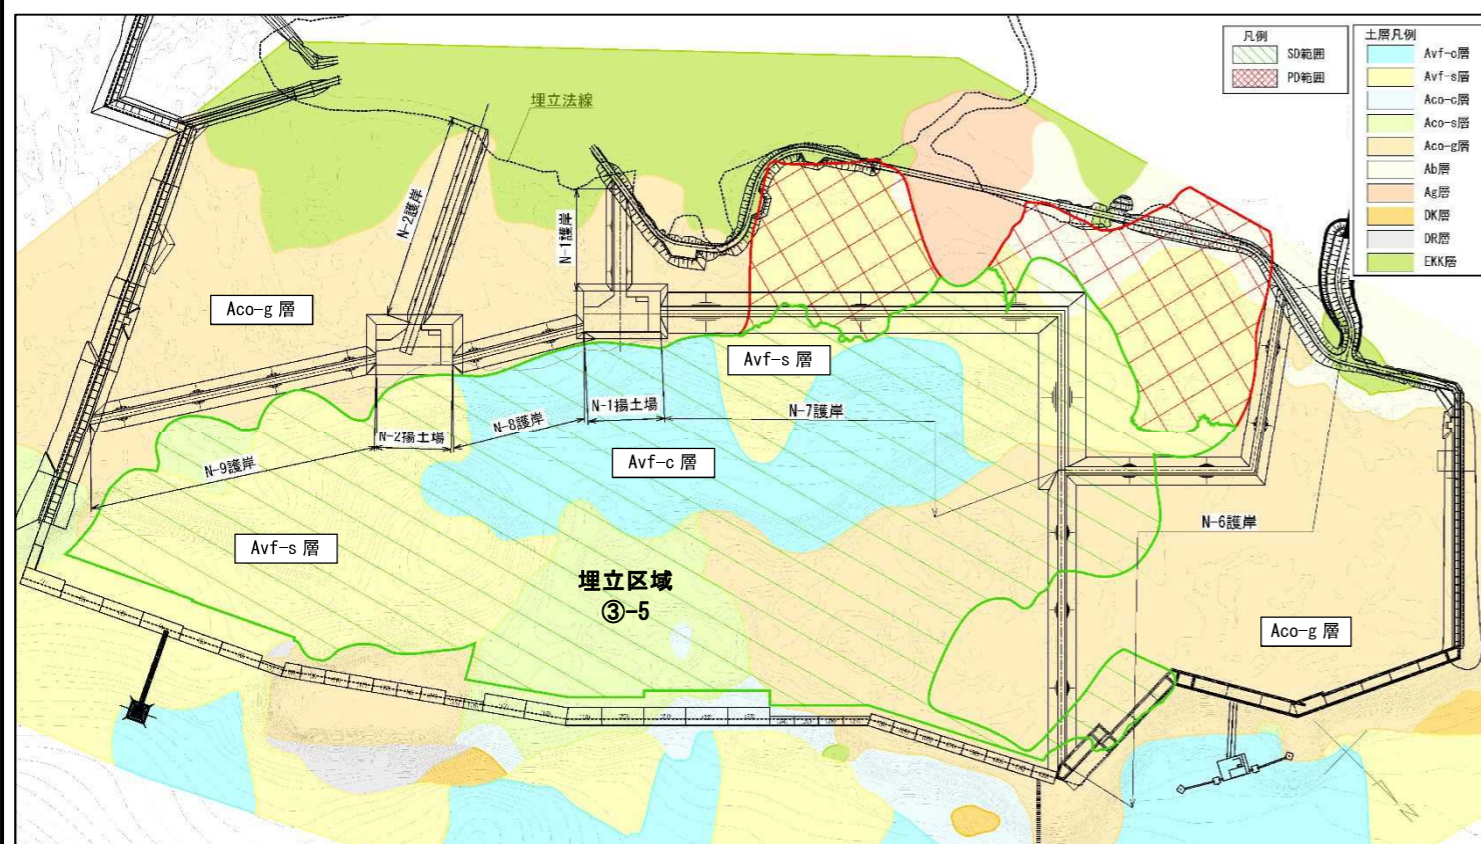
中仕切護岸及び揚土場の平面配置図
